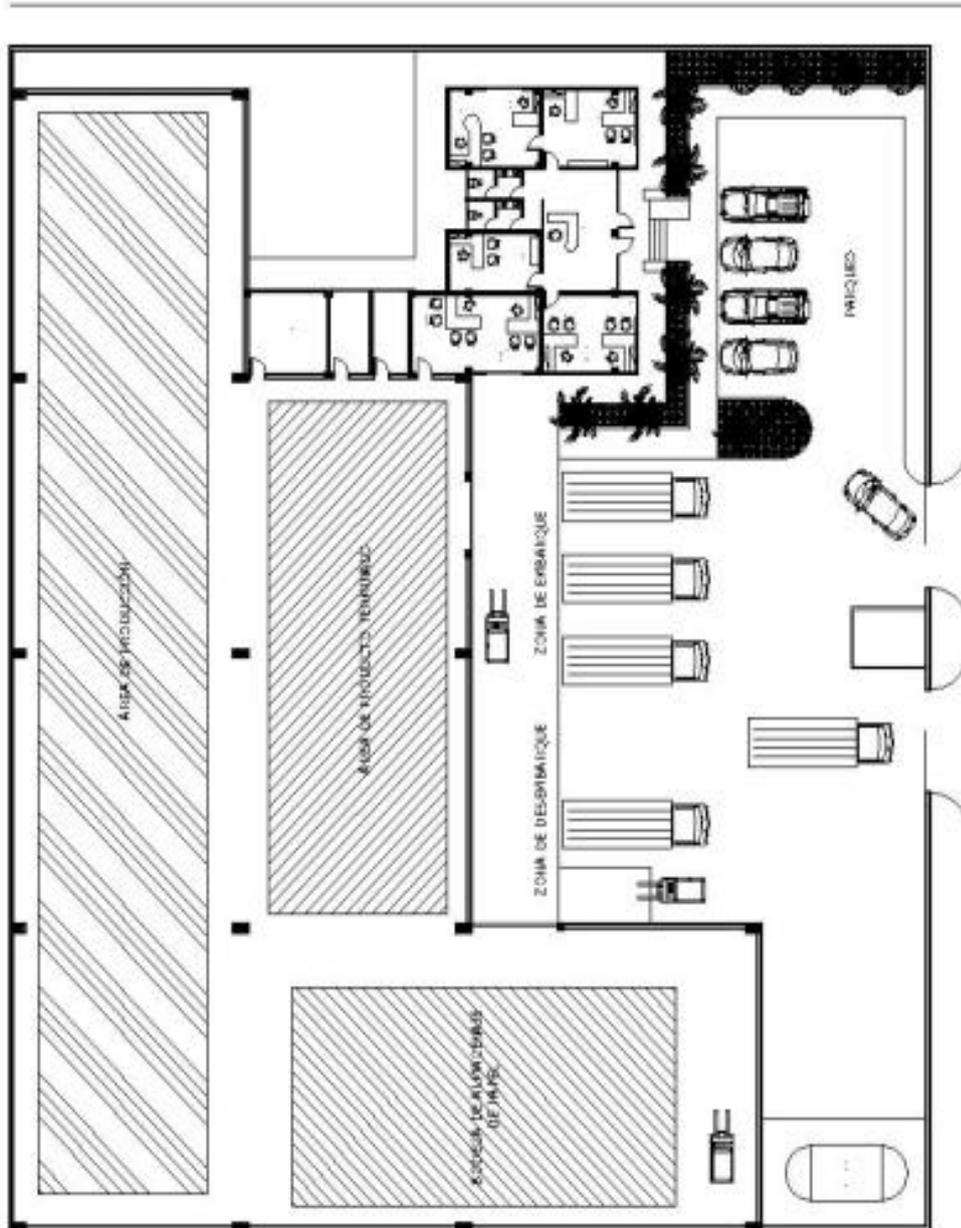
Infraestructura de la Empresa/Diseño Arquitectónico
